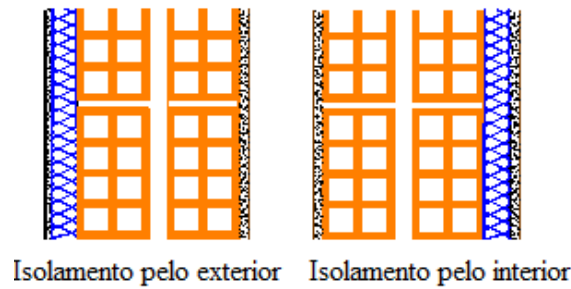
Localização do isolamento de paredes exteriores em alvenaria de tijolo
